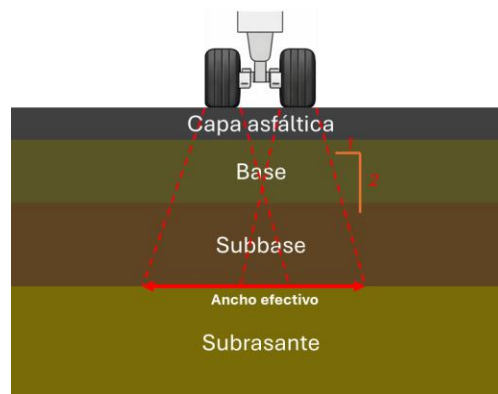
Proyecciones pasadas efectivas en pavimentos asfálticos.
